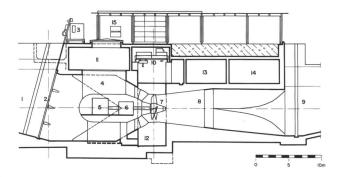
Längsschnitt durch eine Maschinengruppe. 1 Einlauf, 2 Rechen, 3 Rechenreinigungsmaschine, 4 Einstiegschacht, 5 Generator, 6 Getriebe, 7 Turbinen-Laufrad, 8 Saugrohr, 9 Auslauf, 10 35-t-Kran, 11 Steuerraum, 12 Turbinengang, 13 Blocktransformator, 14 Ventilationsraum, 15 Aufenthaltsraum, 16 Hilfsbetriebe, 17 Treppenhaus, Warenaufzug.
